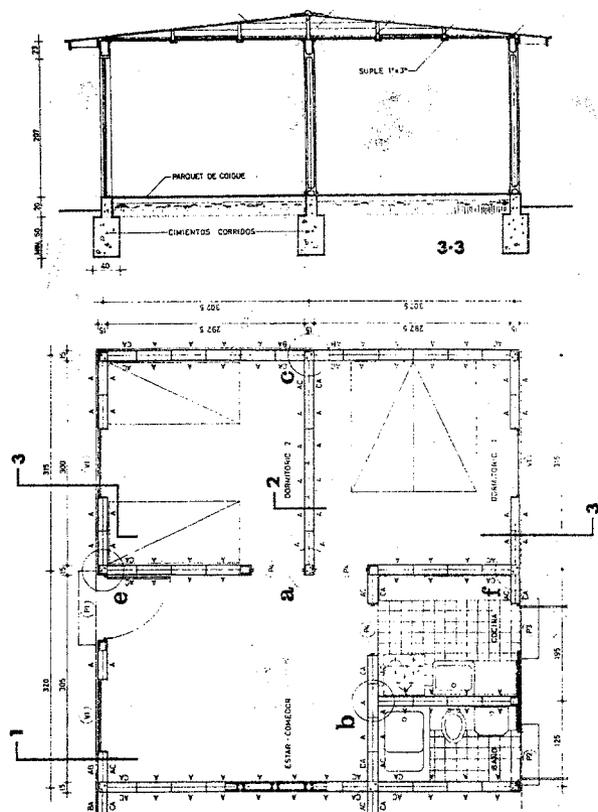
Sistema de prefabricación parcial, cuyos muros están constituidos por 2 caras de elementos prefabricados de hormigón vibrado.
